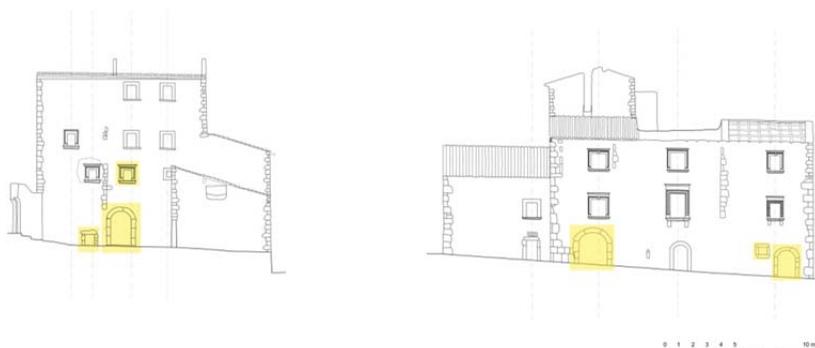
Verifica degli allineamenti delle aperture nei prospetti
